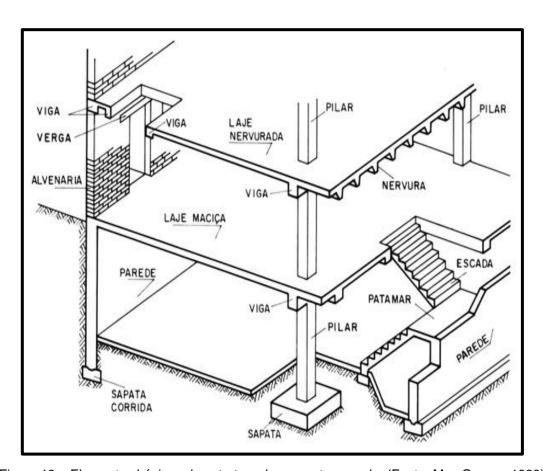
Elementos básicos da estrutura de concreto armado. (Fonte: Mac Gregor ,1988)
